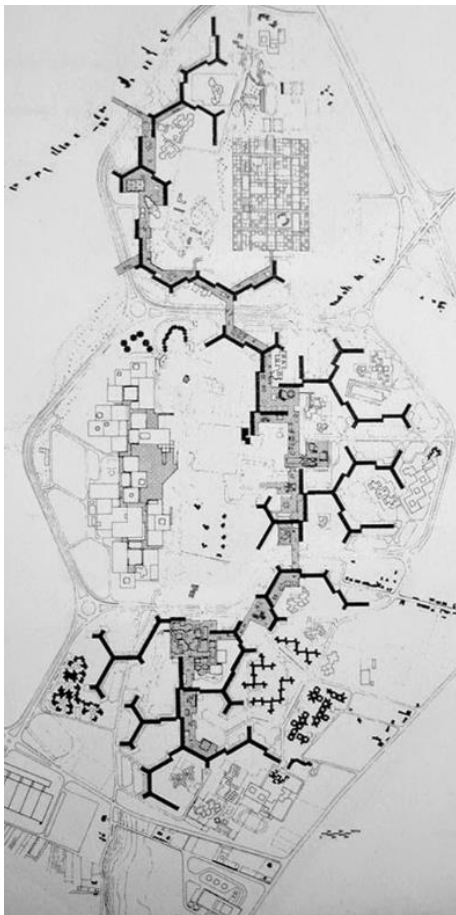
| Primeira fase do projeto "Le Mirail" subdivisão dos três bairros principais
